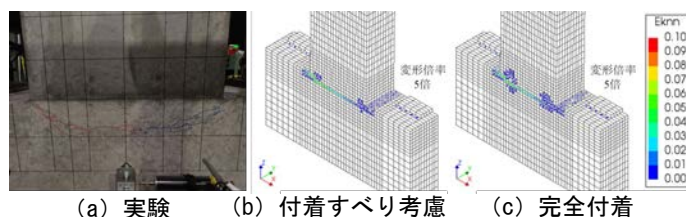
RG-D13の実験および解析のひび割れ状況 (δ=+3mm)
